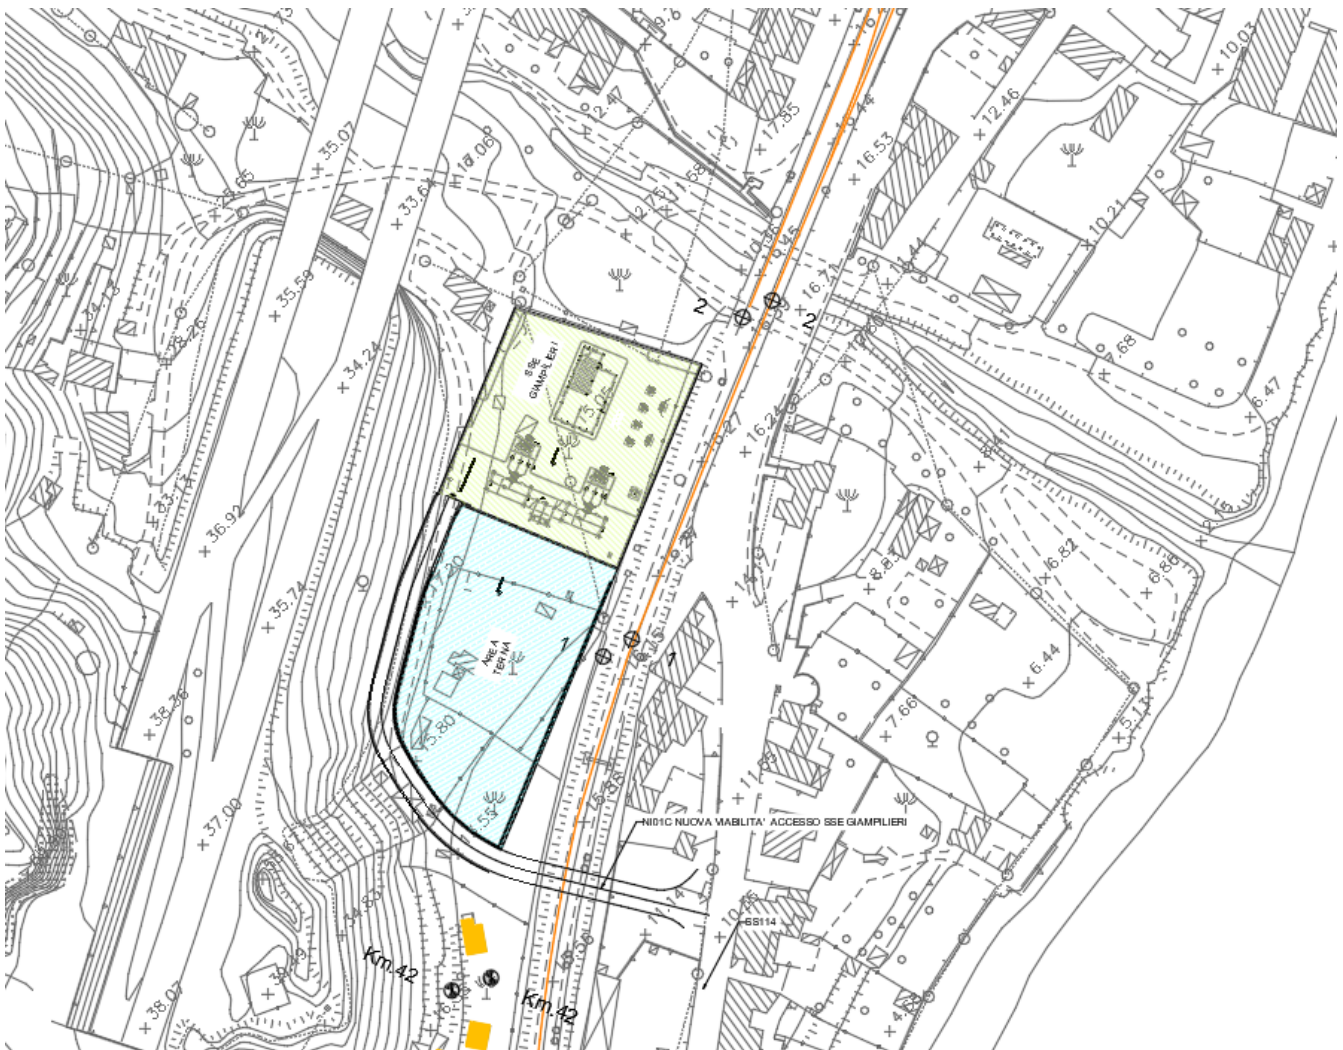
Straccio planimetria SSE Giampileri (ME)
